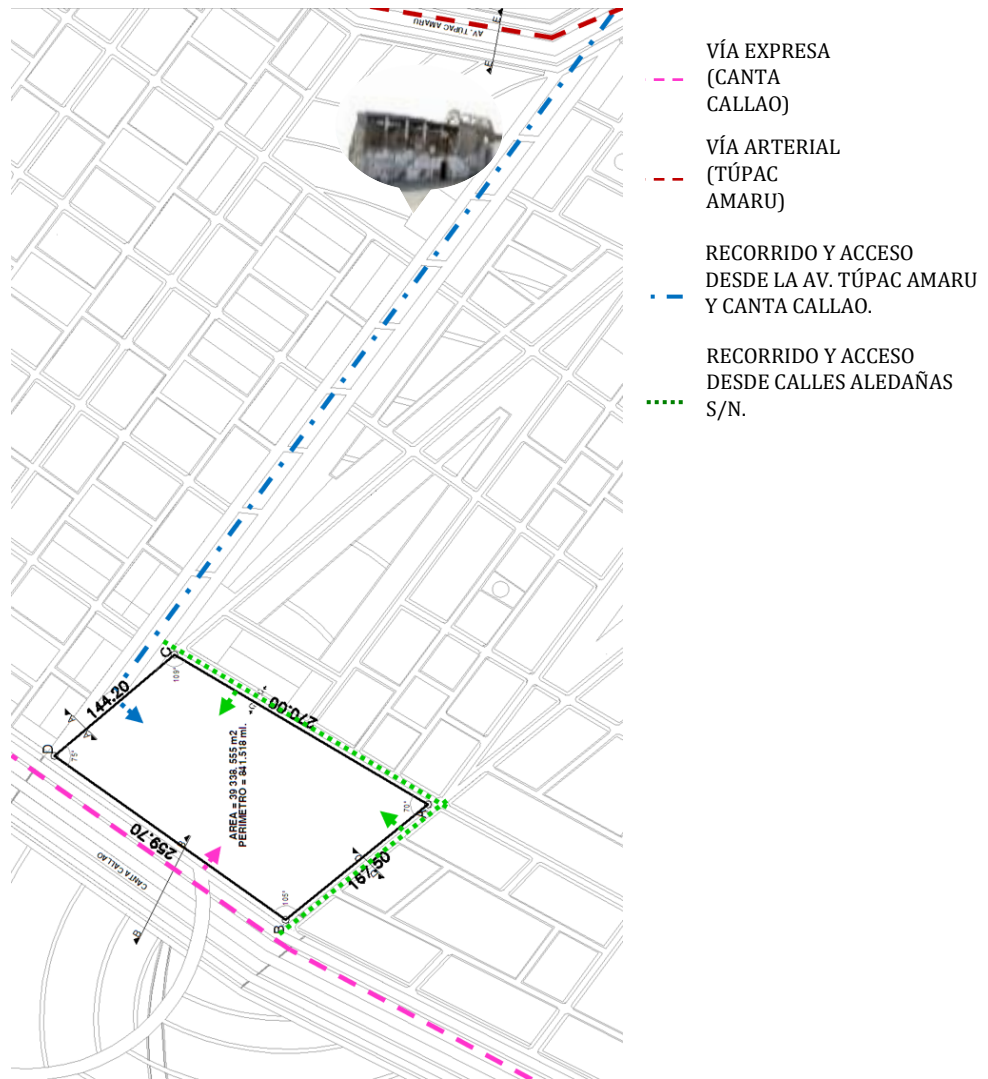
Acceso de vías principales al proyecto arquitectónico. Fuente: Elaboración propia.
